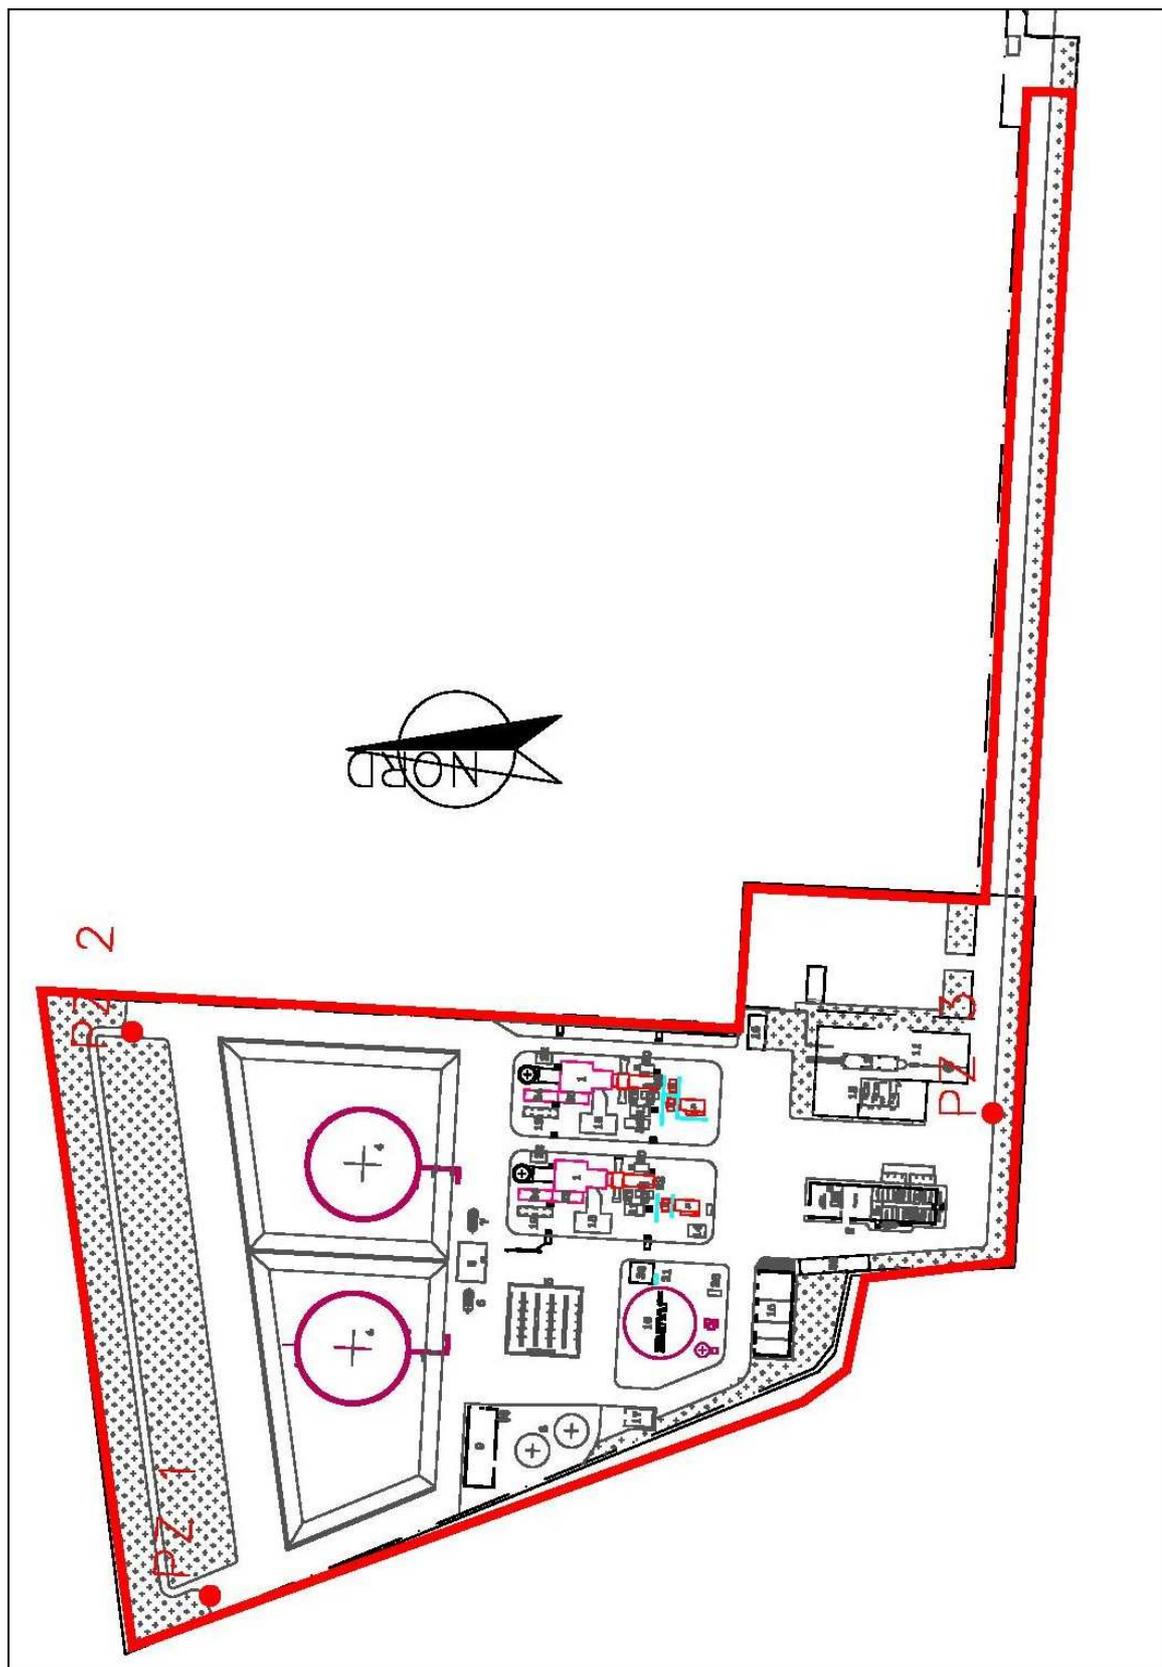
Area del sito con ipotesi di posizione dei piezometri
